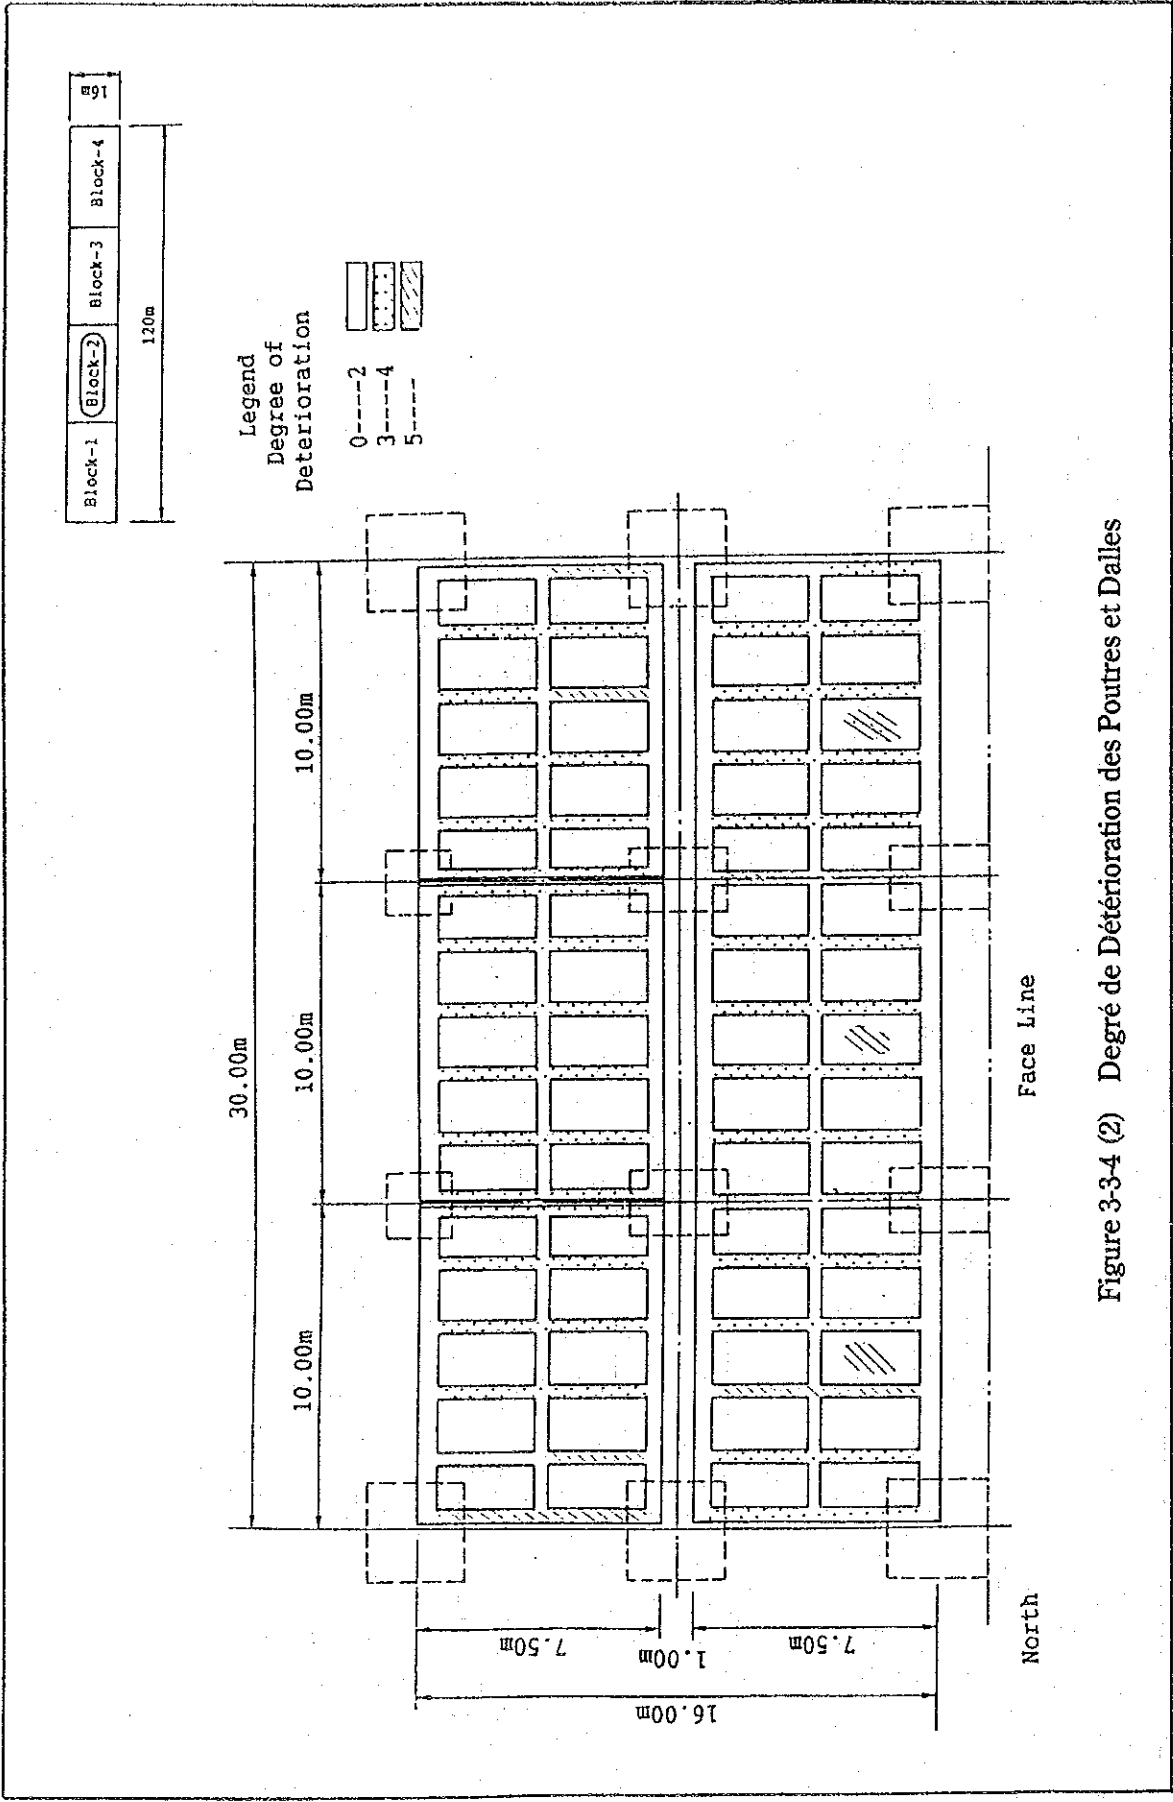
(2) Degré de Détérioration des Poutres et Dalles
